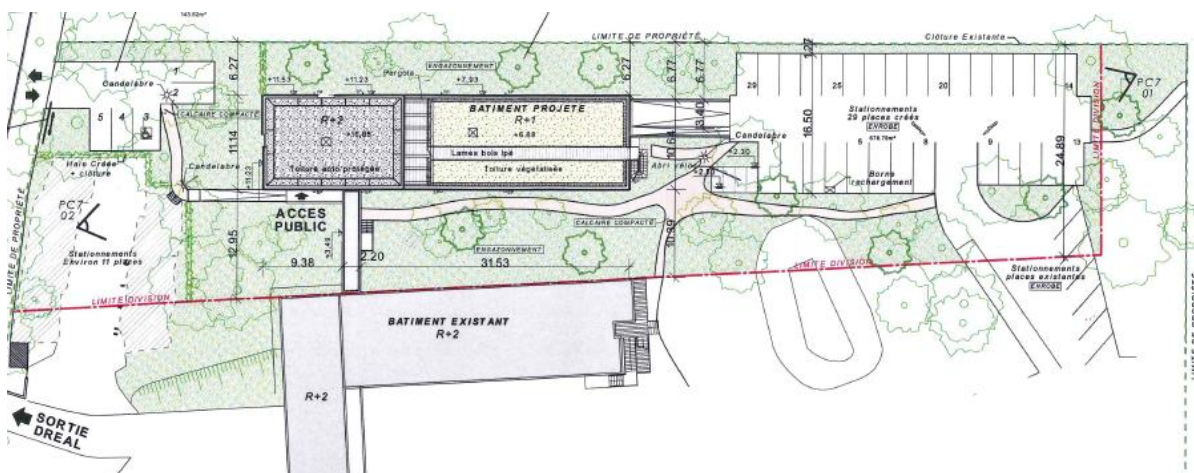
Plan de masse des nouveaux bureaux de la DREAL Centre
